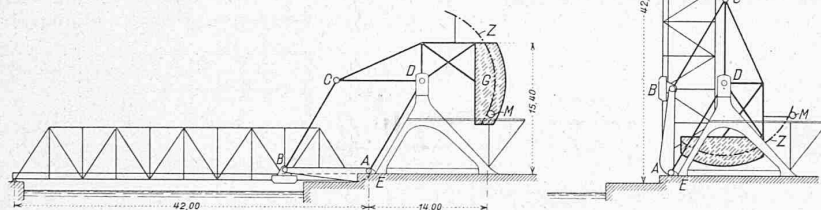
und 2. Schema der Klappbrücke in geschlossener und offener Stellung.
